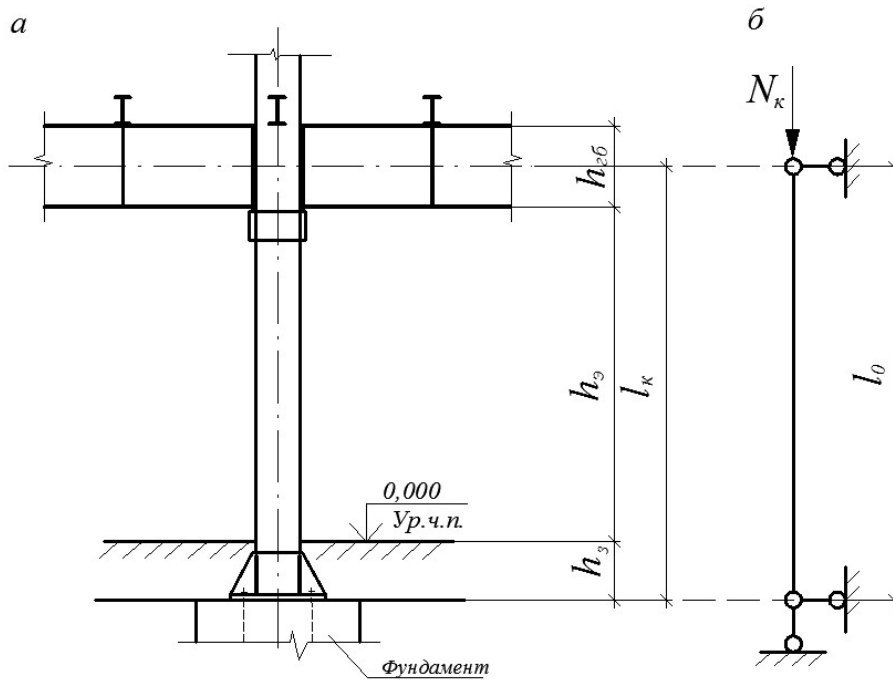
Схемы к расчету колонны: *а* – конструктивная схема; *б* – расчетная схема;  $N_k$  – расчетная нагрузка на колонну 1-го этажа
